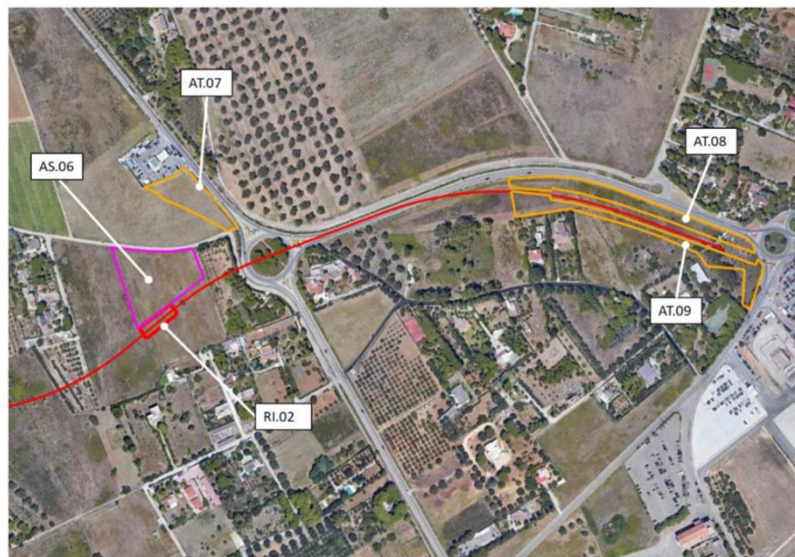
Scenario 2: Aree di cantiere oggetto di modellazione in Aermid View
